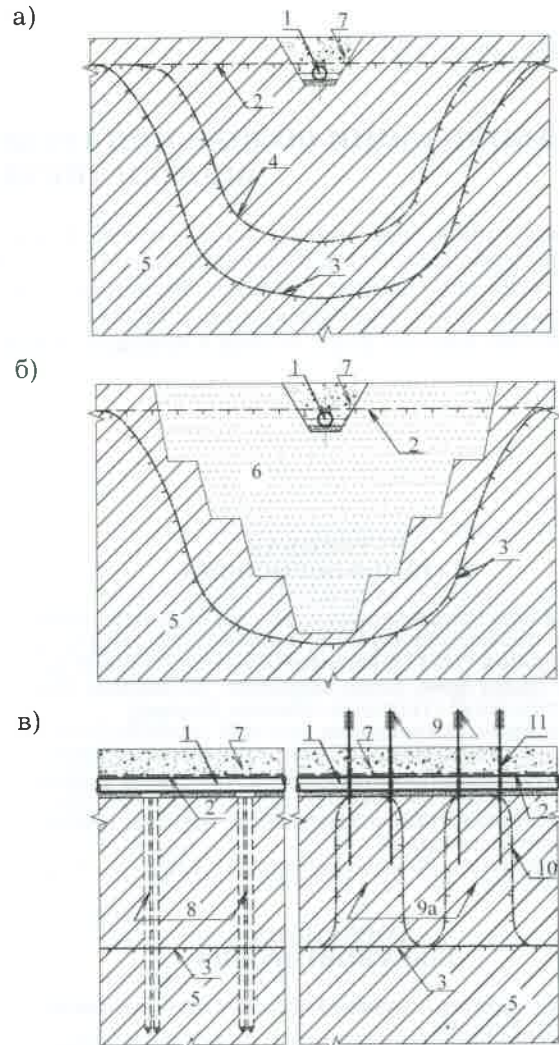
Традиционные решения стабилизации положения трубопровода с помощью кольцевой теплоизоляции (а); замена просадочных грунтов (б); устройство свайных и льдогрунтовых опор (в):
